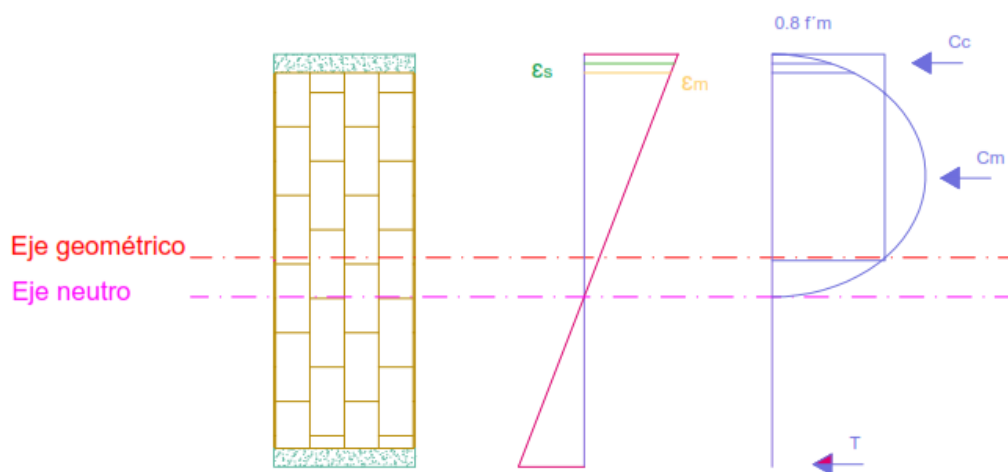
Diagrama de esfuerzo y deformación de la mampostería confinada.
